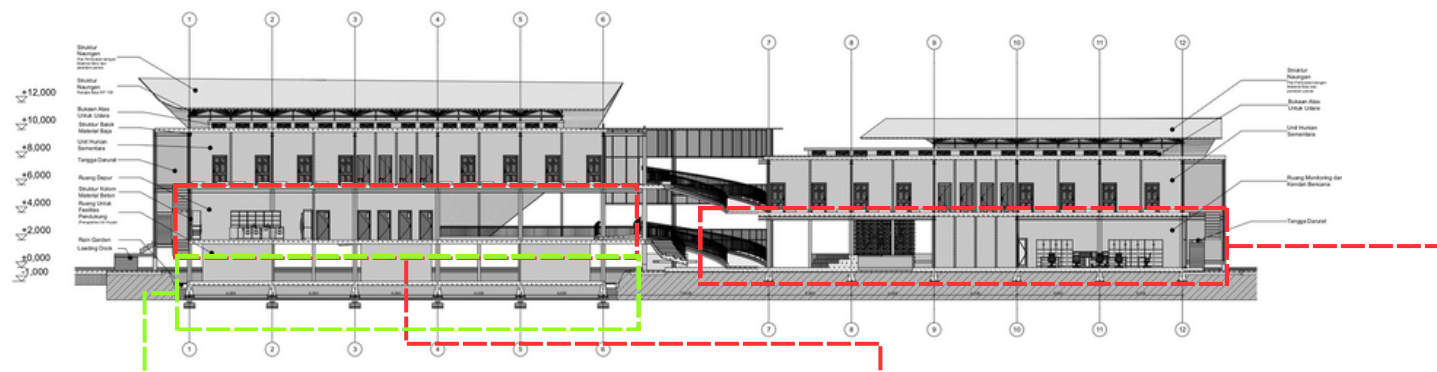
Penggunaan Manajemen bencana dalam penataan ruang
